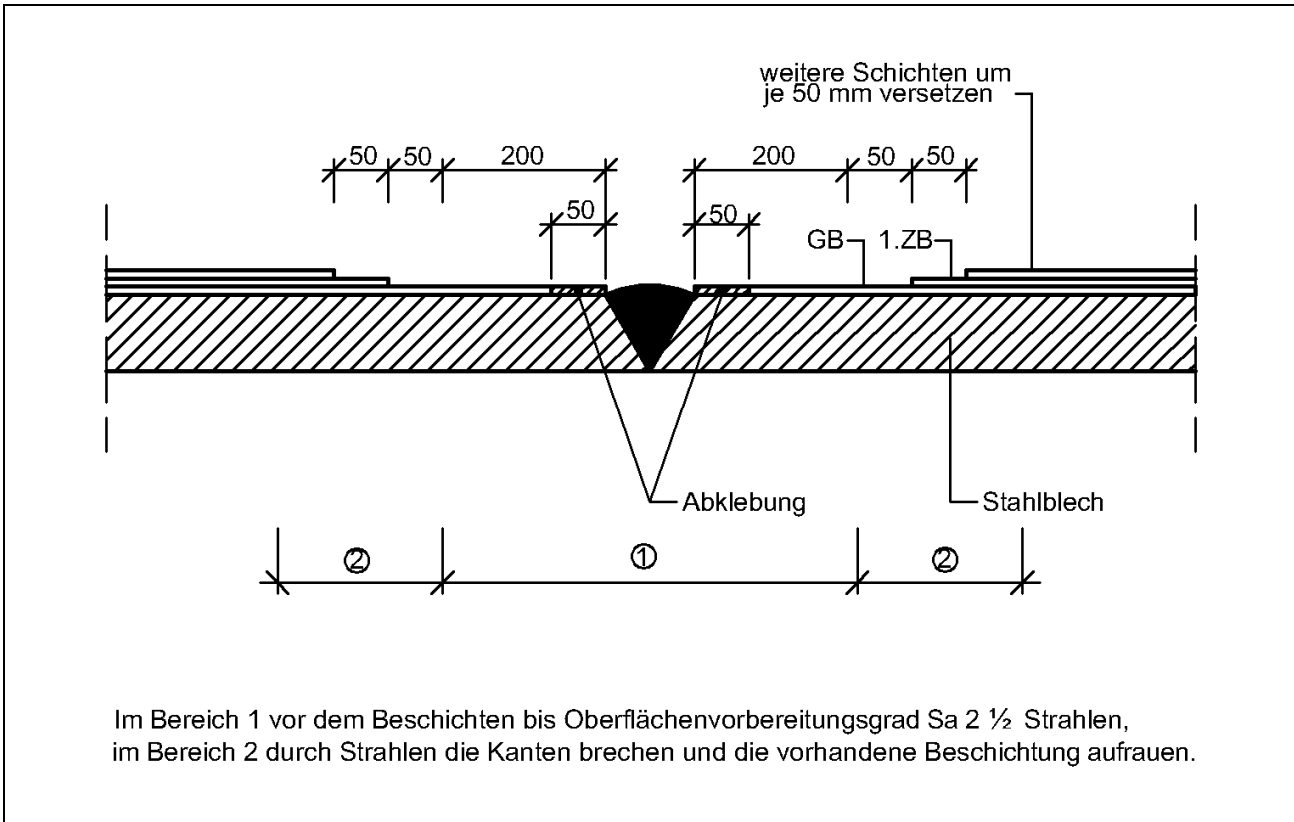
Gestaltung der Korrosionsschutzbeschichtung im Bereich von Baustellenschweißstößen
